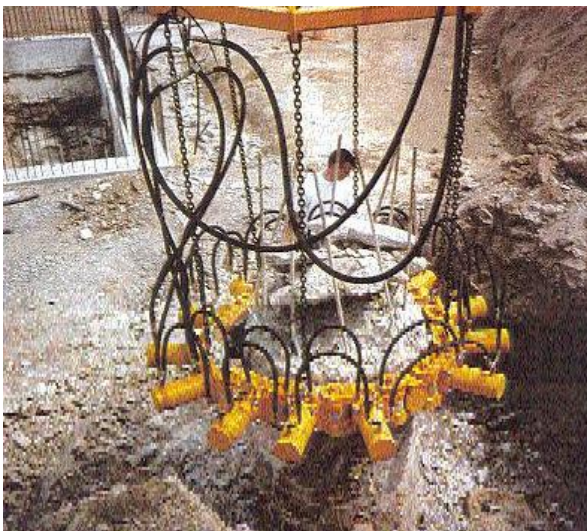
, Equipos PB para descabece de pilotes y pilas
